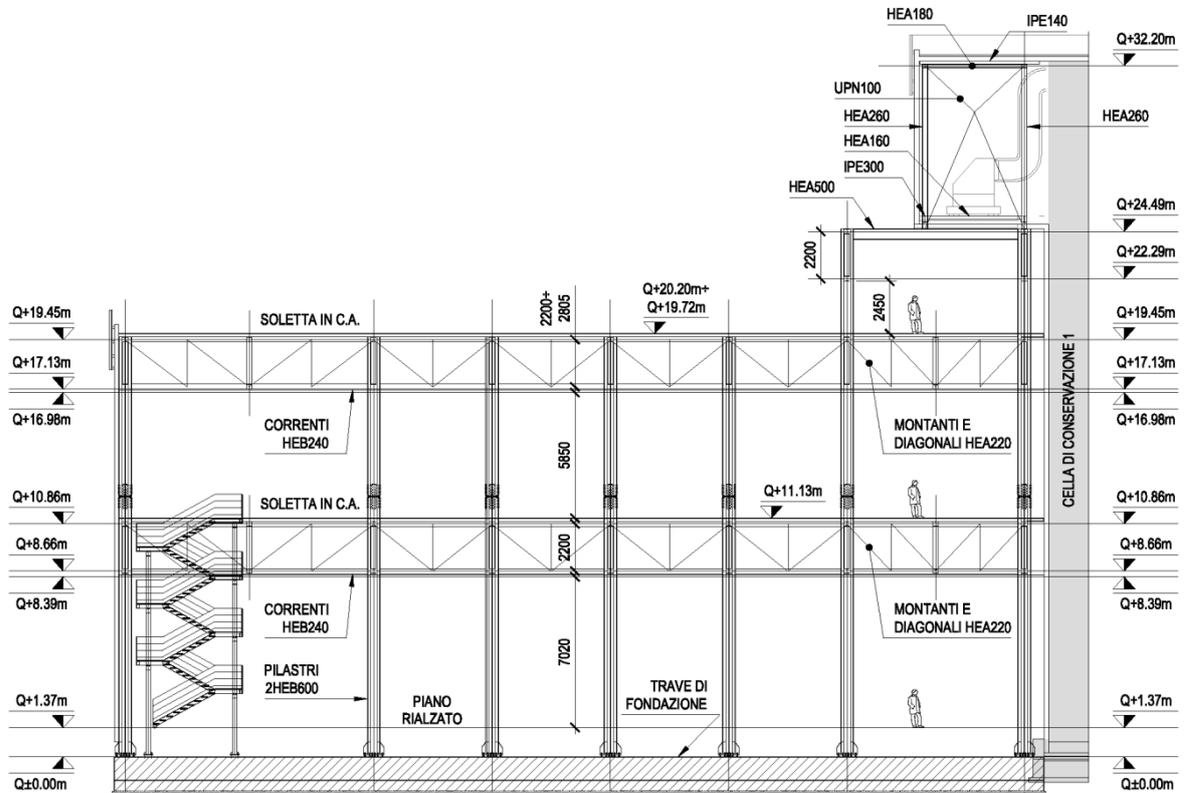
Sezione trasversale tipo struttura di elevazione
